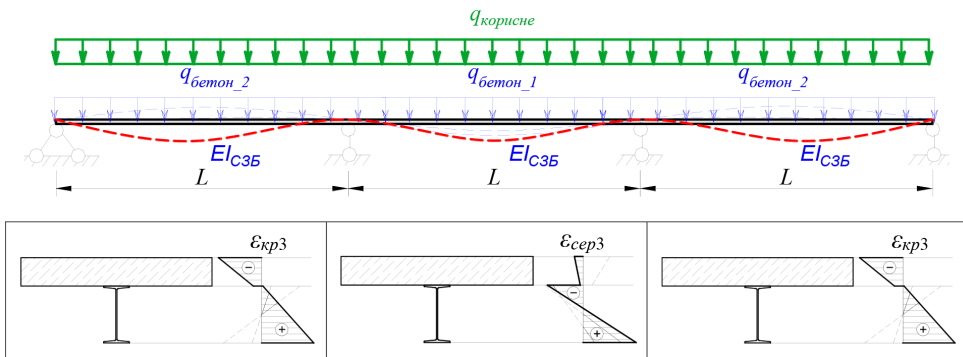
Етапи влаштування попередньо напруженої власною вагою нерозрізної сталезалізобетонної плити перекриття
